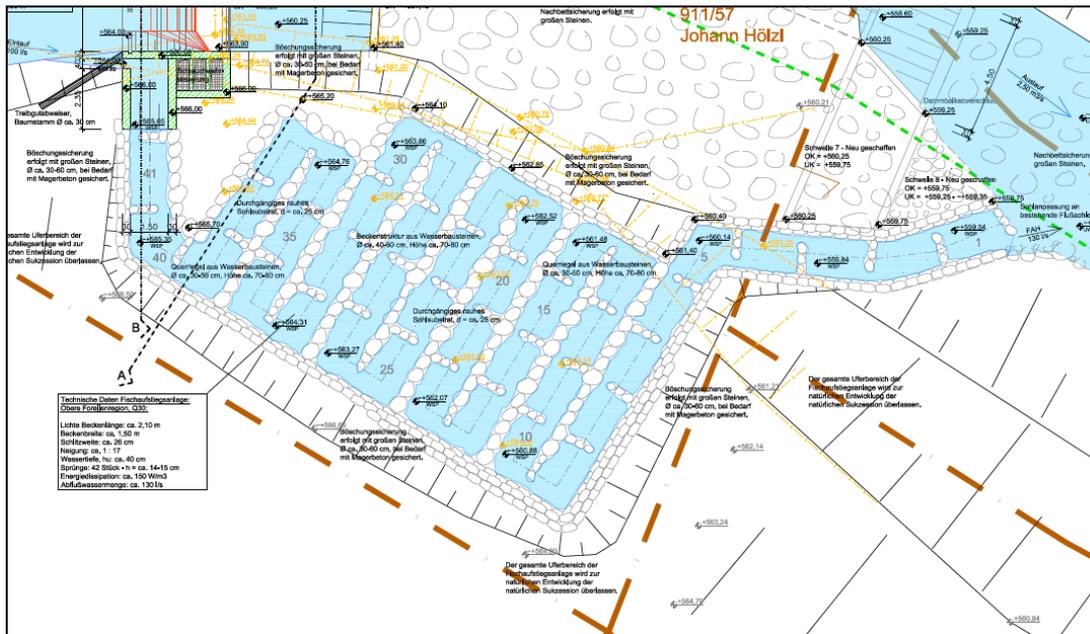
Lageplan Fischaufstieg - Planung (Auszug aus der Planung von Ederer 2018)
